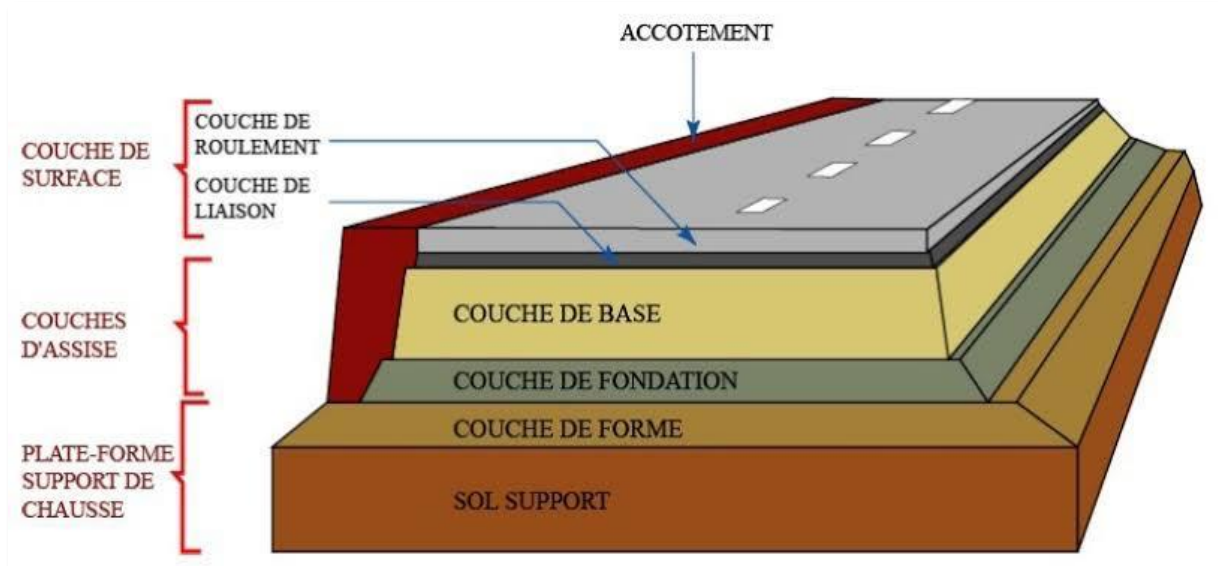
Coupe type d'une structure de chaussée et terminologie des différentes couches [10]
